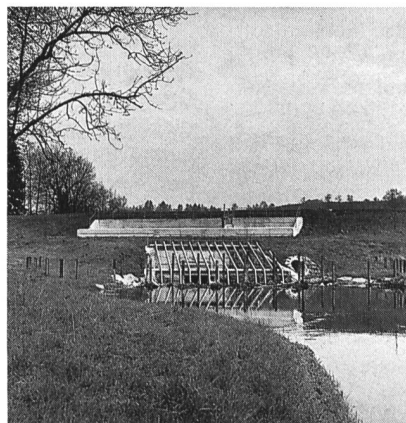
Einlaufbauwerk von Grundablass (mit Rechen) und Hochwasserentlastung.
